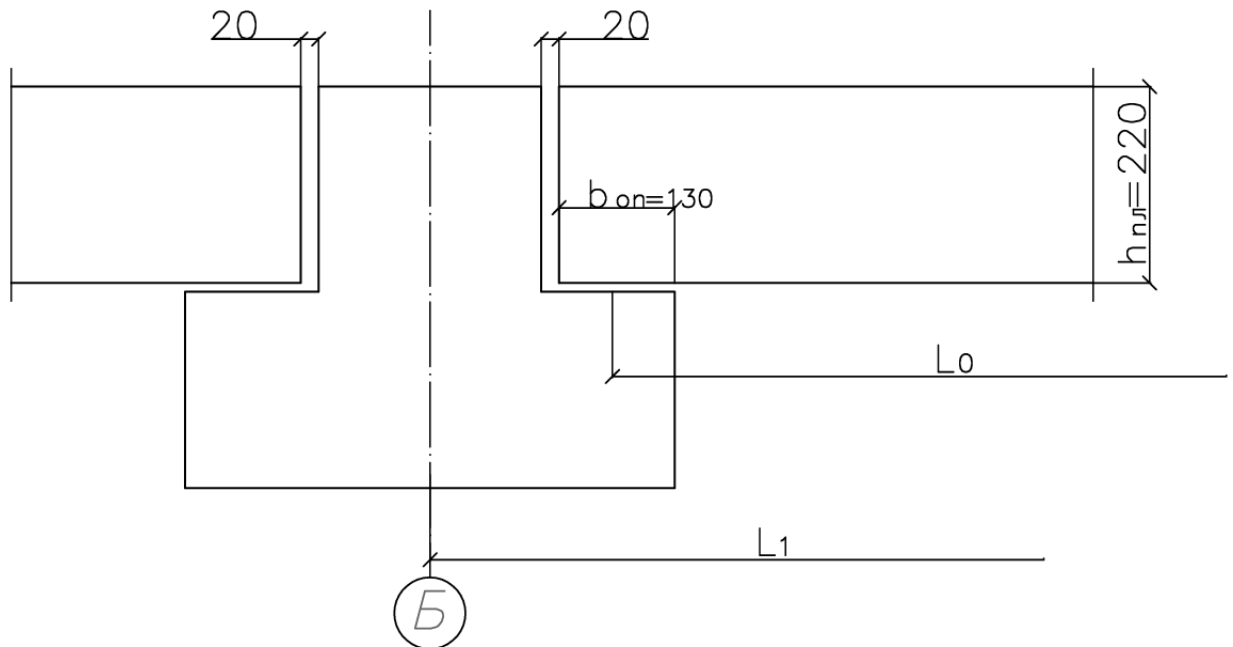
Схема узла опирания панели на ригель таврового сечения.
